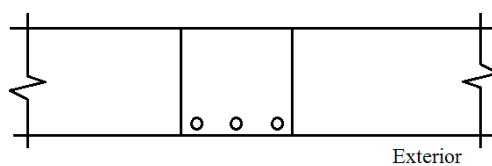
Disposição de armaduras na face exterior do pilar, Tipo II.
